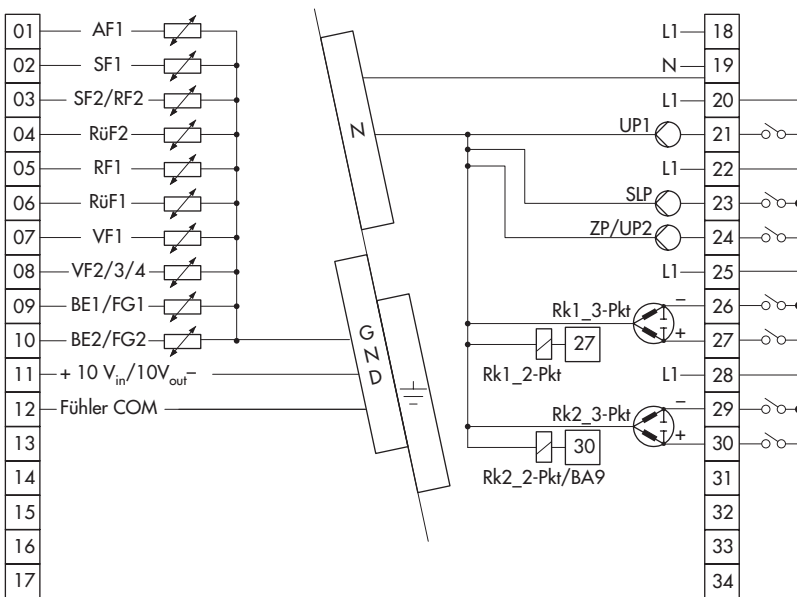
· Anschlussbelegung des Reglers TROVIS 5573 mit hohem Gehäuserückteil
